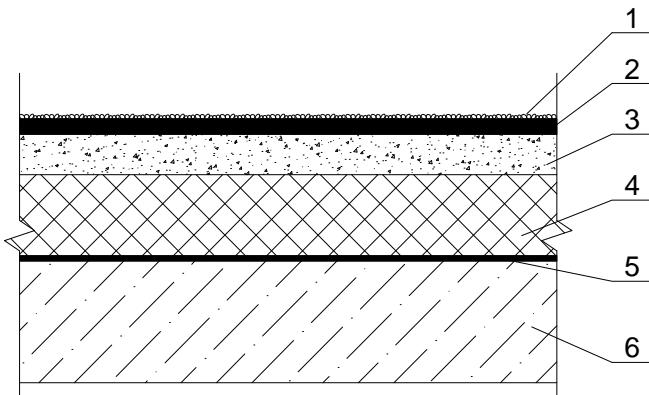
Совмещённая кровля с прямым размещением слоев:
